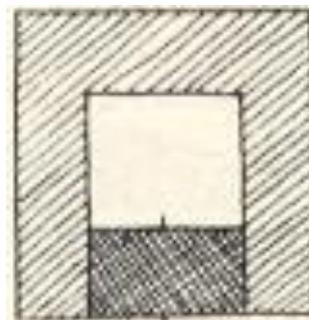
Grundriss des Vierkanthofes (nach HECKL 1949, S.64)
